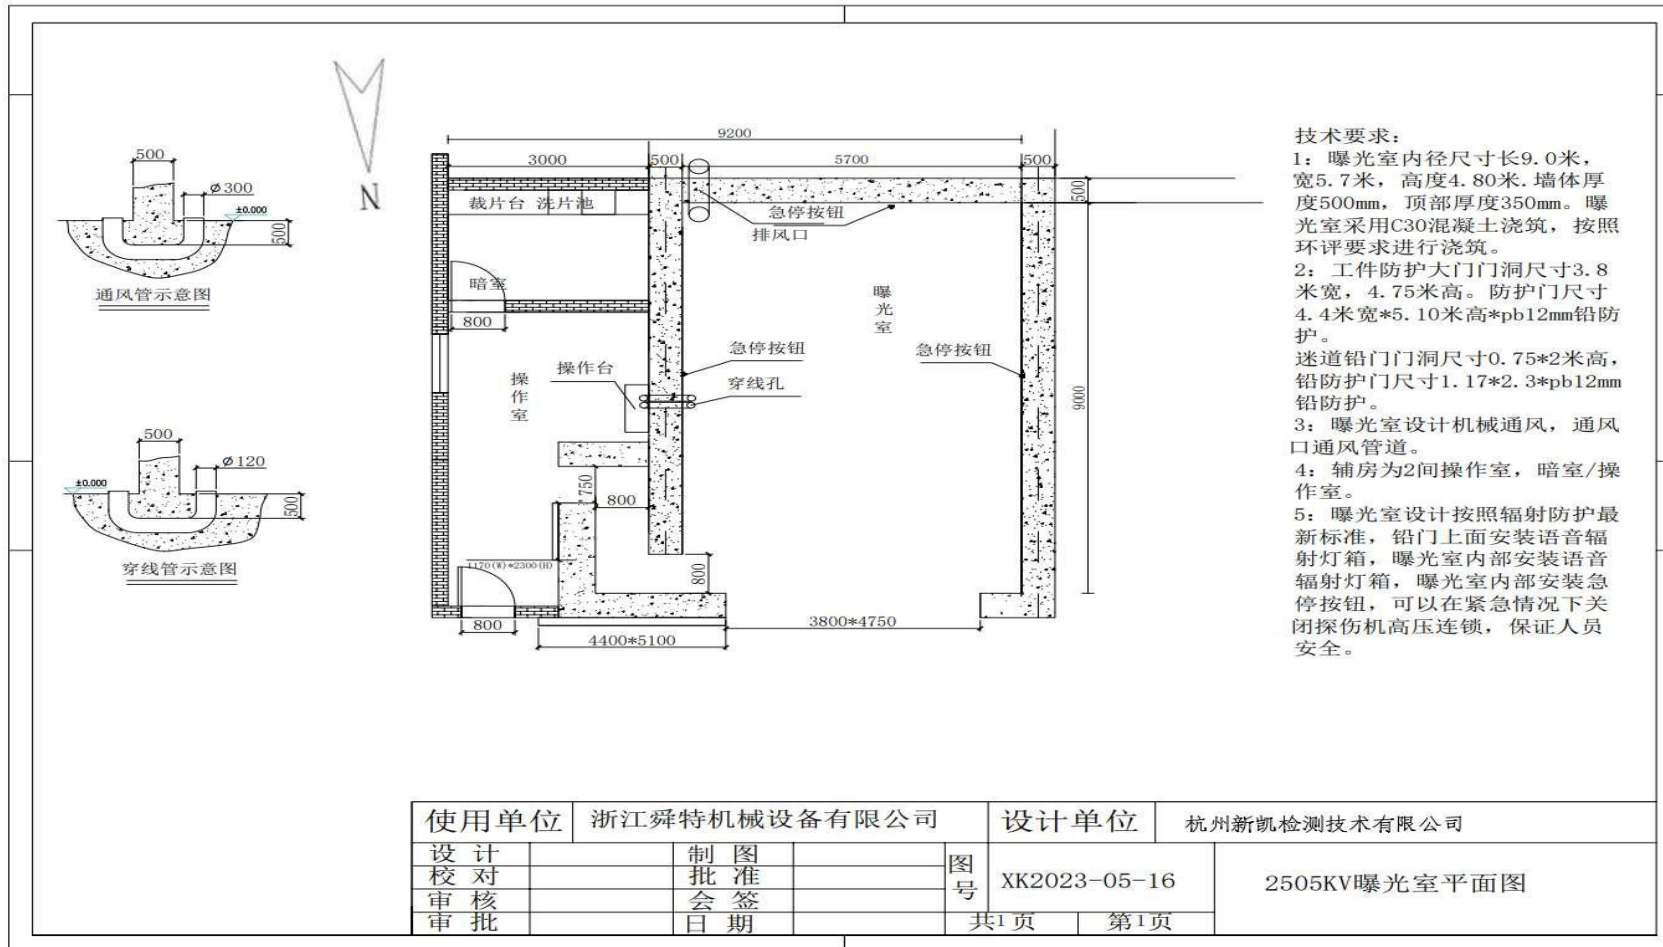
探伤室探伤室平面图及穿线管、通风管示意图
